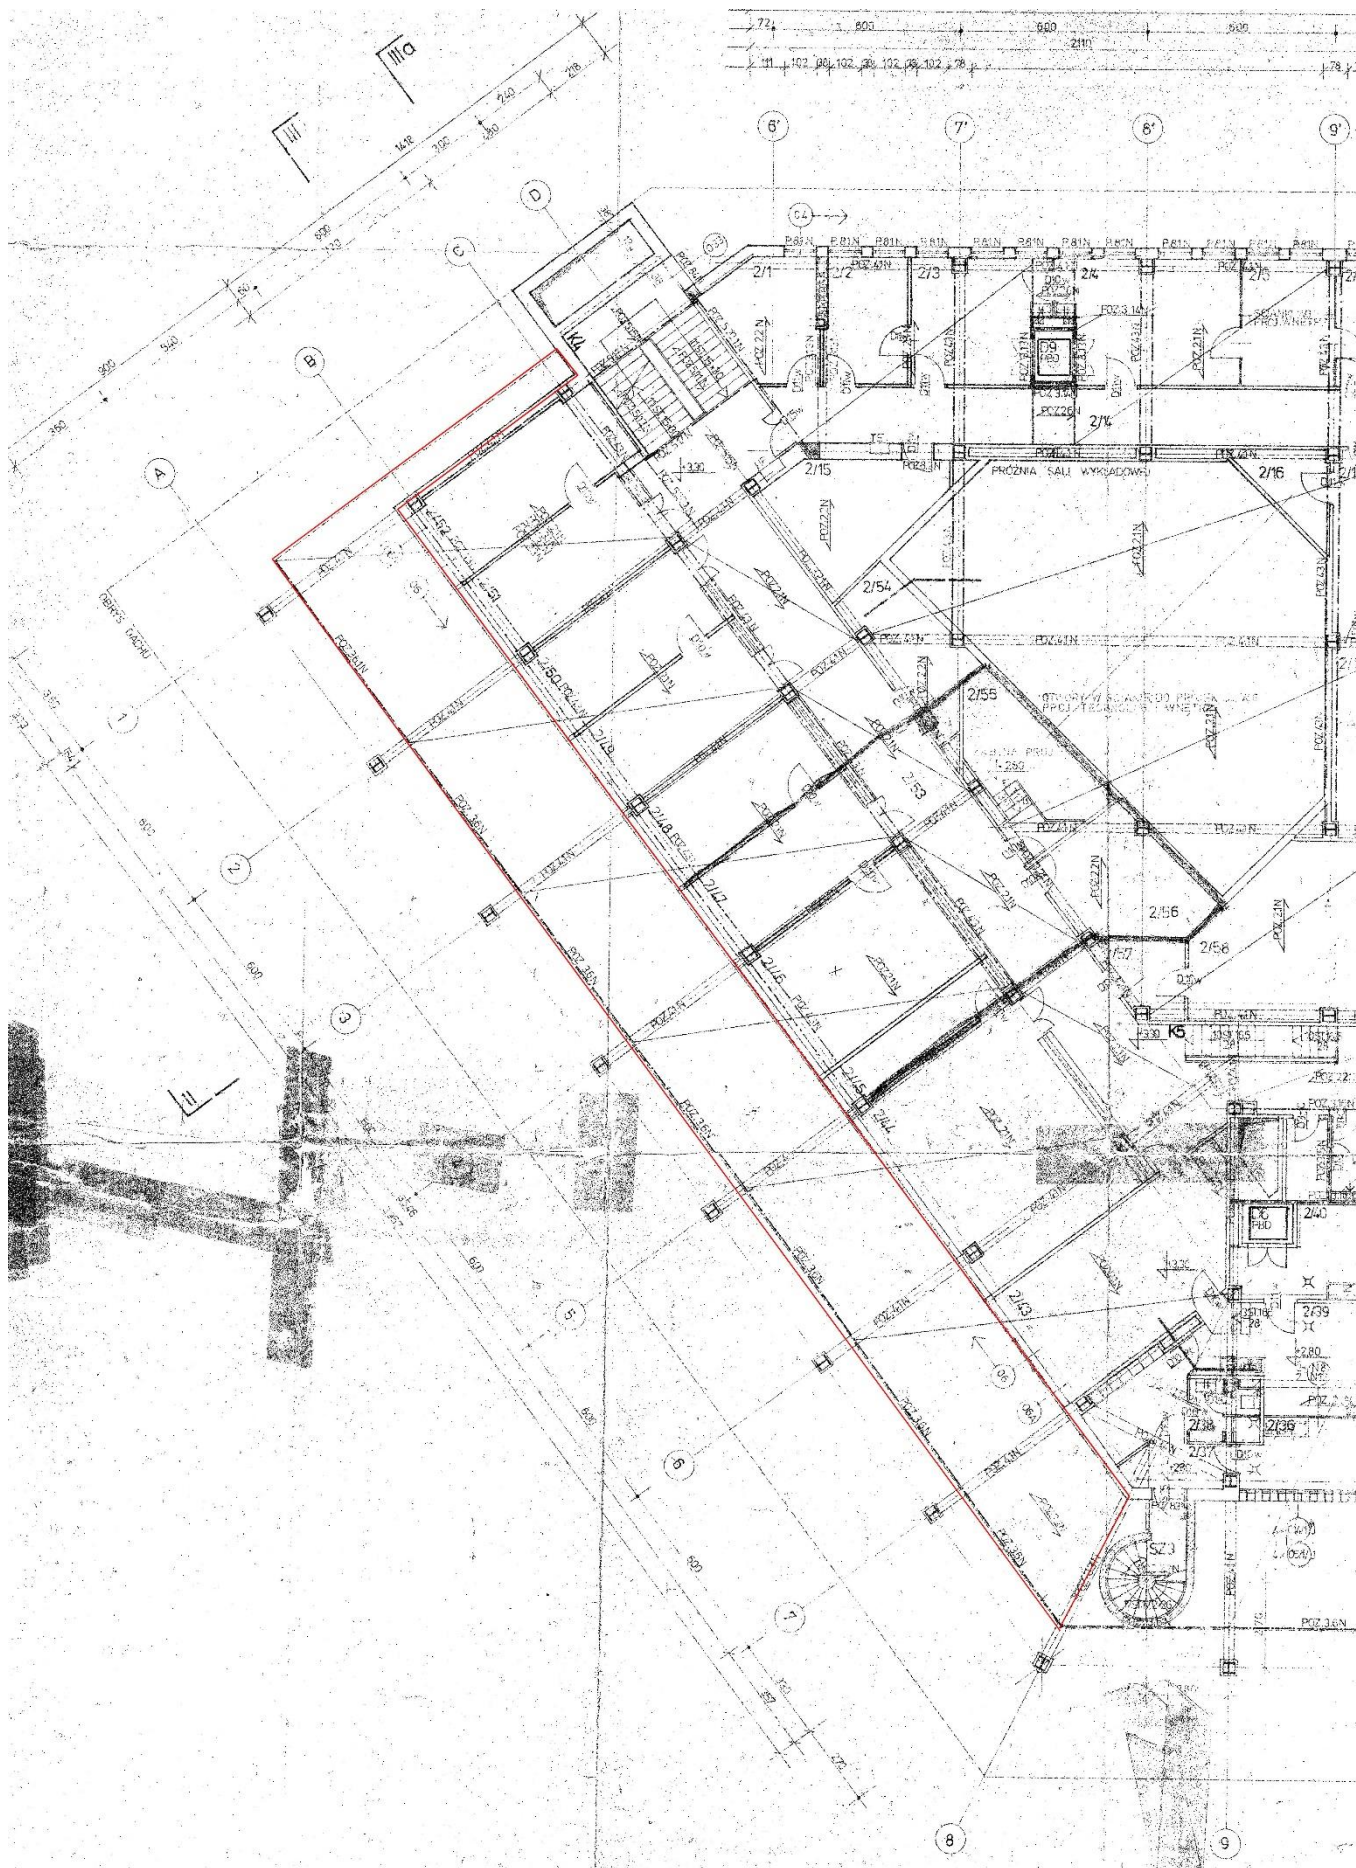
Lokalizacja analizowanych płyt korytkowych nad III piętrem – kolor czerwony.
